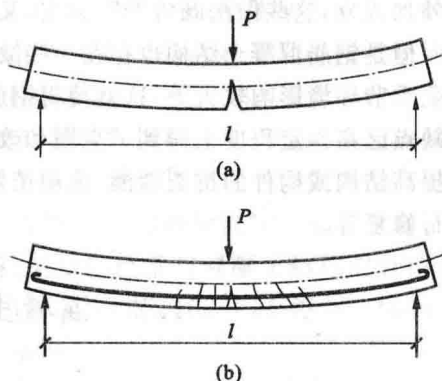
素混凝土梁和钢筋混凝土梁的破坏情况
